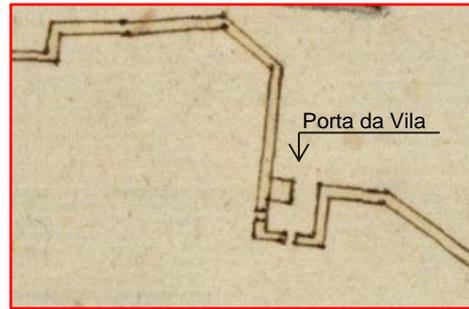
Desenho da planta da Porta da Vila. Pormenor da Figura 9. Assinalámos a Porta da Vila.
